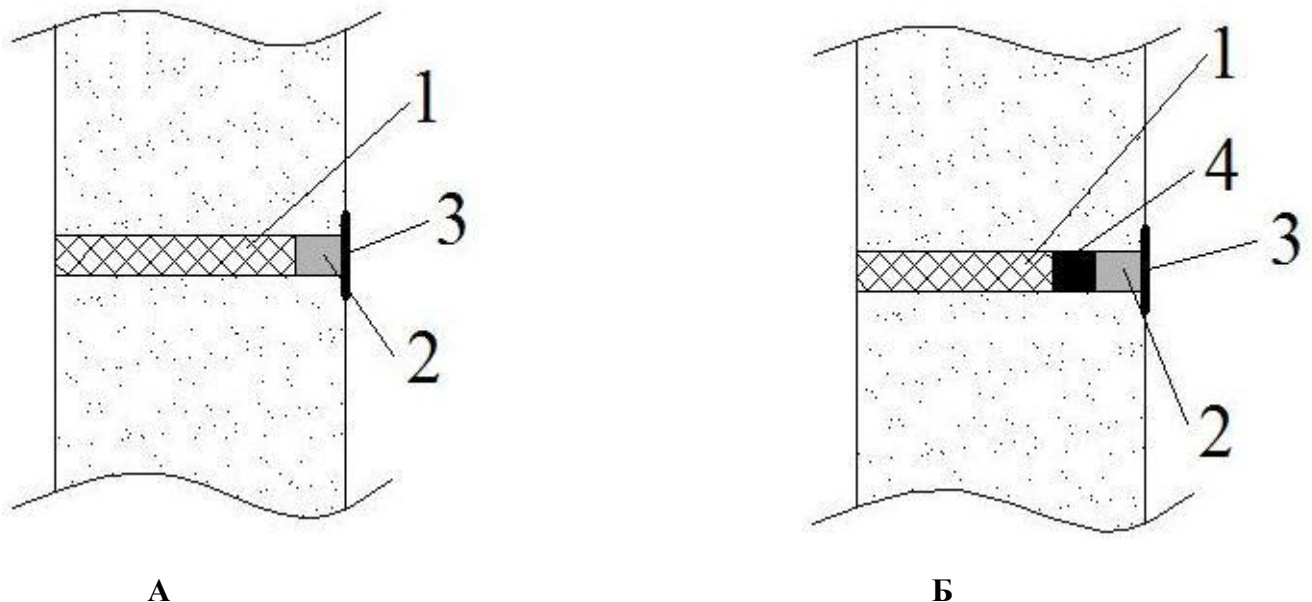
Гидроизоляция отверстий от стяжек опалубки:
